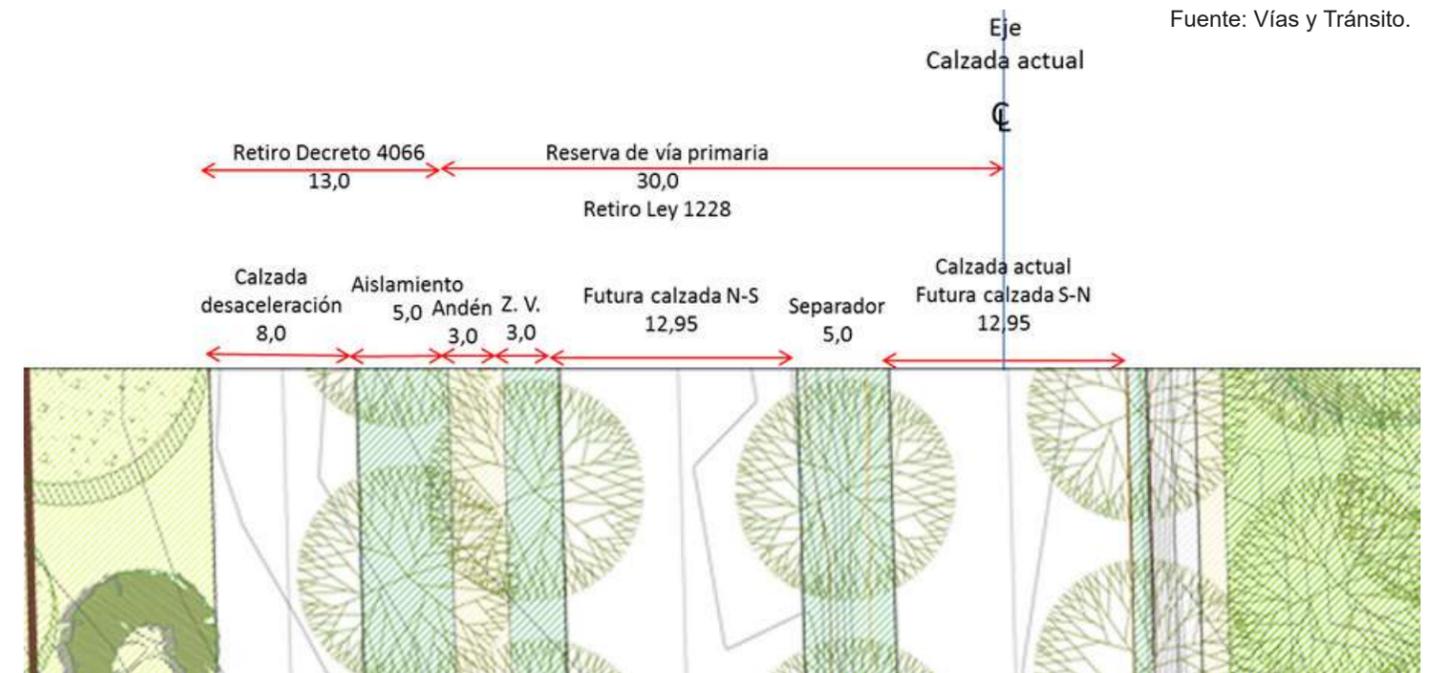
Propuesta de redistribución de la sección transversal de la vía primaria sin afectar la calzada actual ni la ciclorruta en construcción
